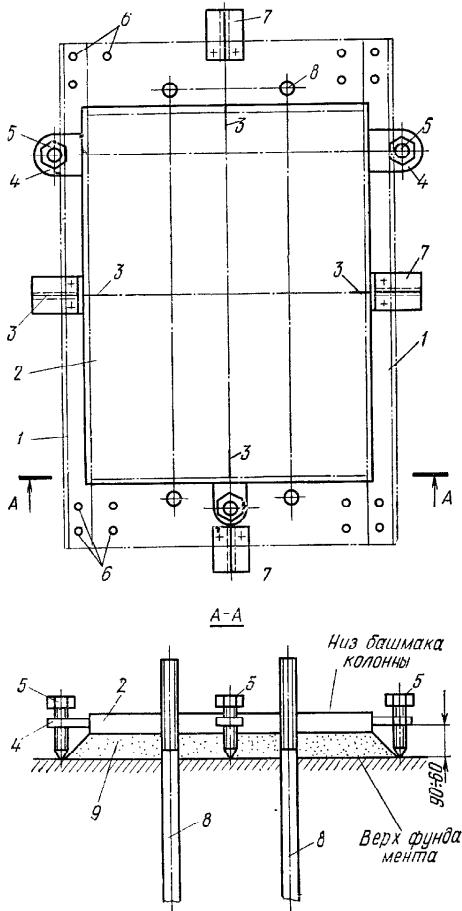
Установка анкерных болтов, закладных частей и опорной плиты при безвыверочном способе монтажа:
